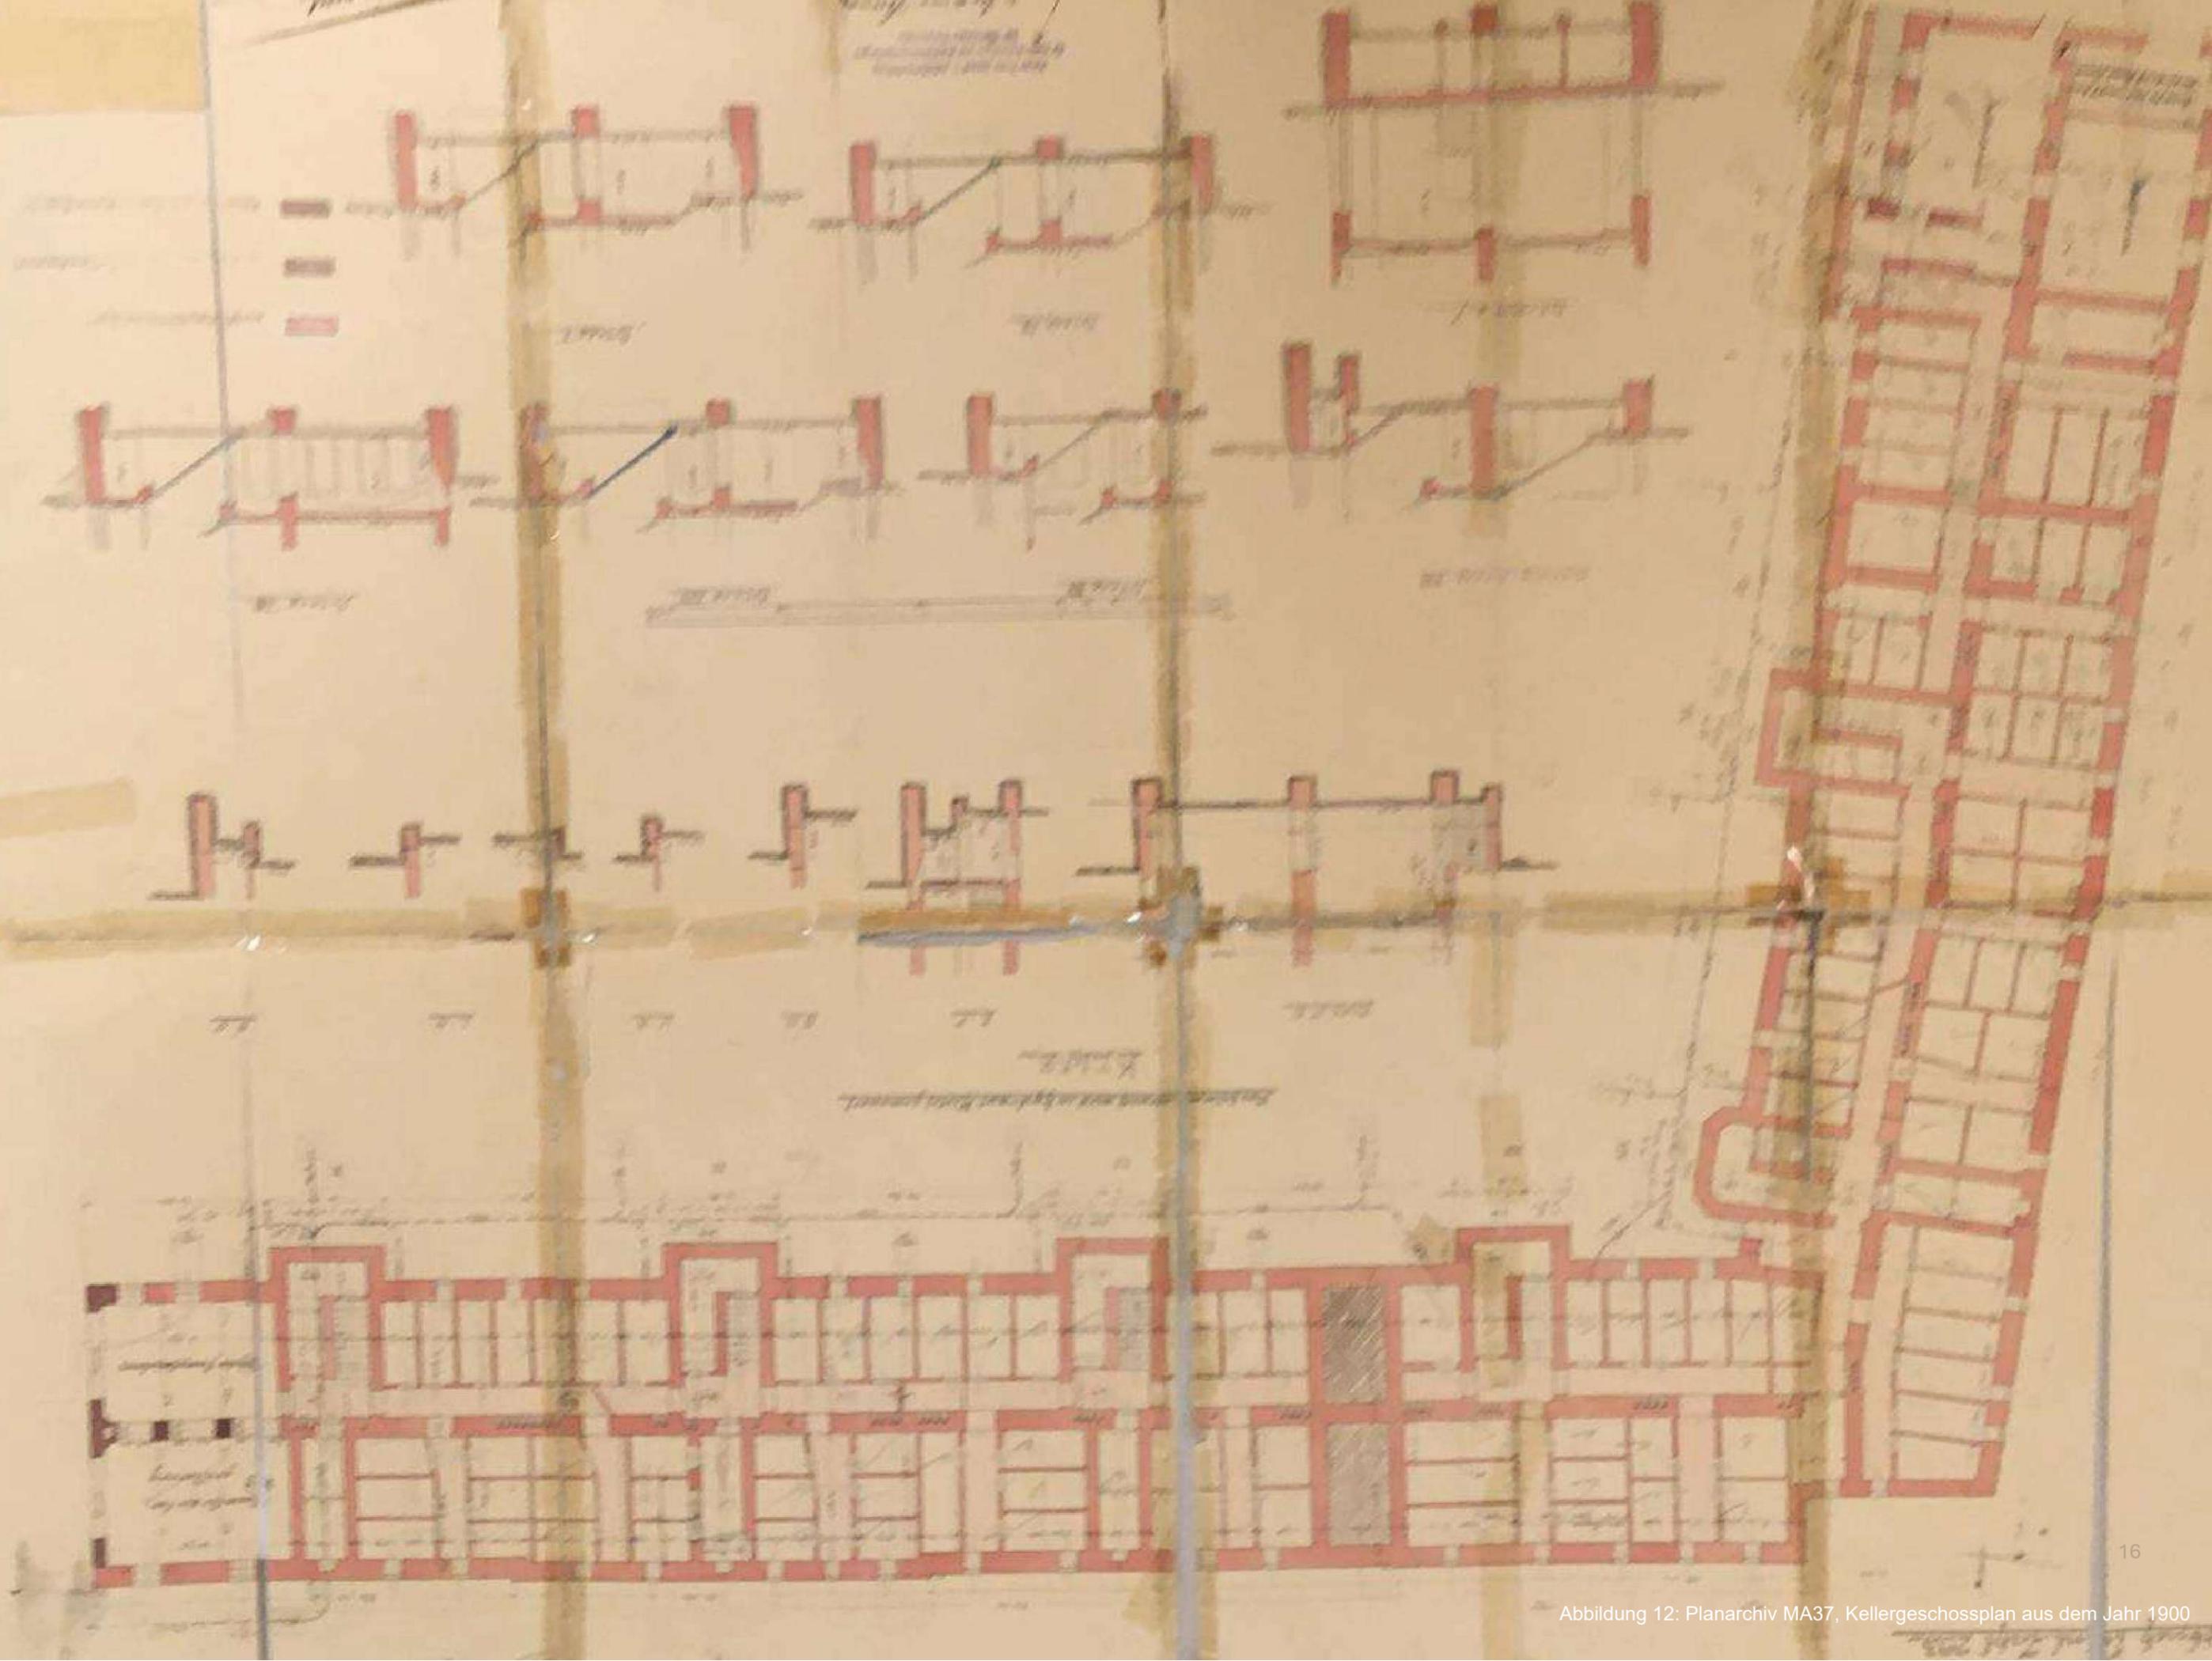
Planarchiv MA37, Kellergeschossplan aus dem Jahr 1900
